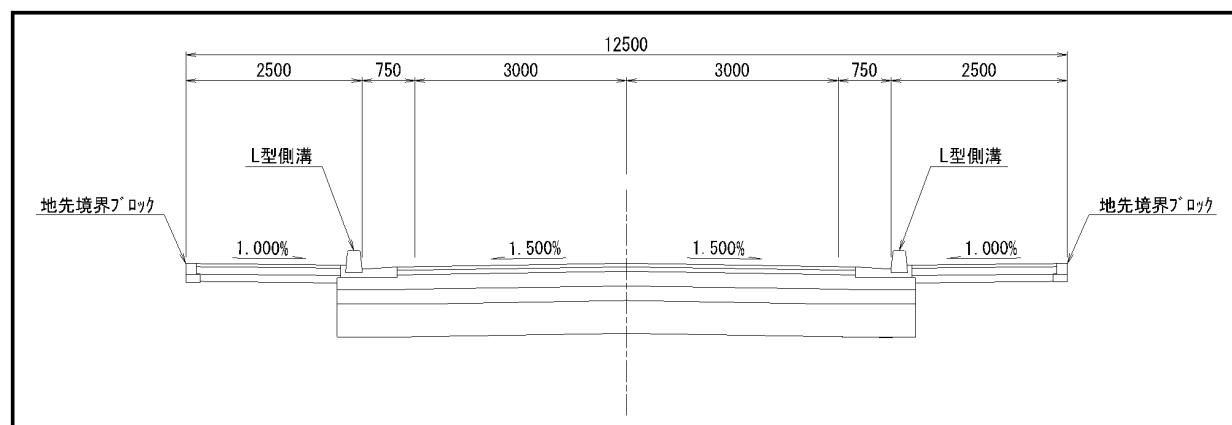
(2) 道路の標準断面図（幹線道路 12.5-2 号線 幅員 12.5m）
